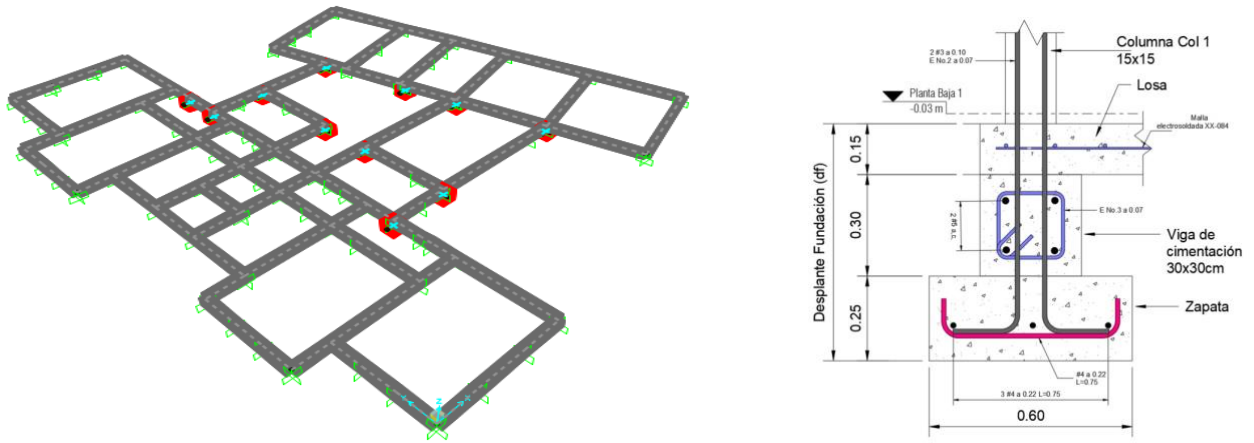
Planta de cimentación sitios de revisión correspondiente a las cargas puntuales más altas (puntos en rojo) y corte de cimentación.
